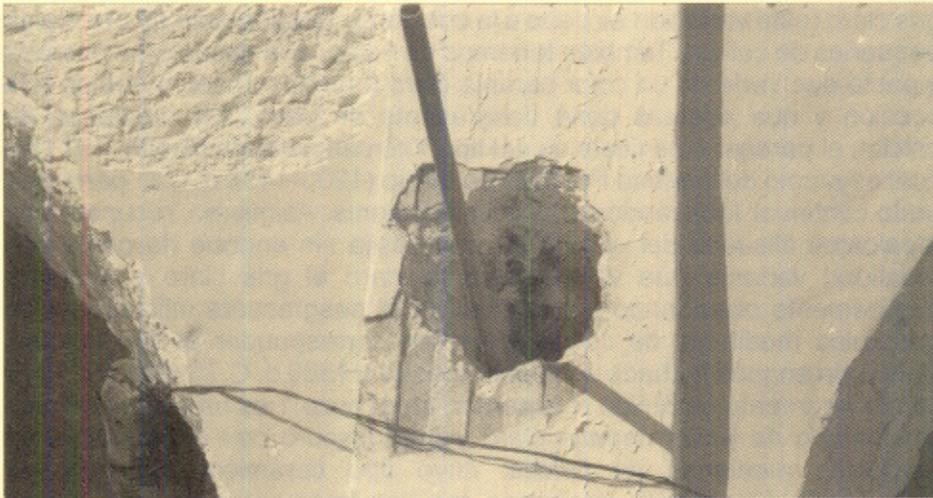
Detalle de la decoración estriada hallada detrás del revoco.
